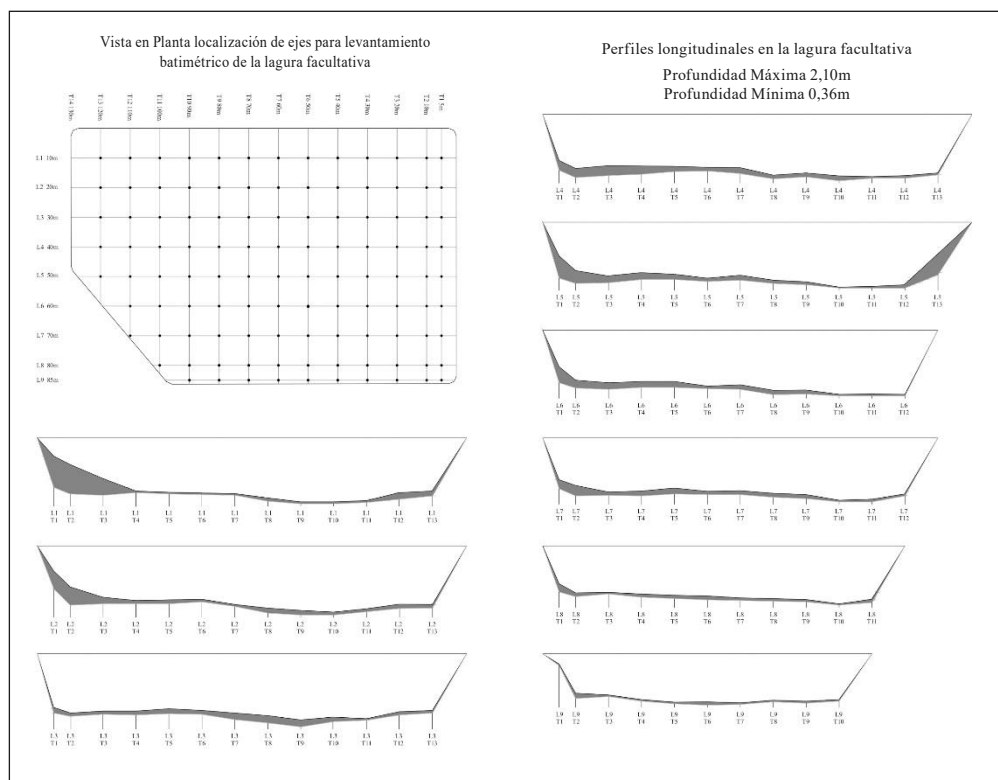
Vista en planta y perfiles longitudinales de la laguna facultativa
